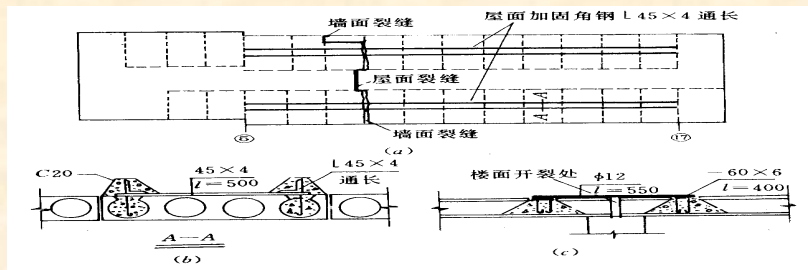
屋面开裂情况及屋（楼）面加固处理示意
